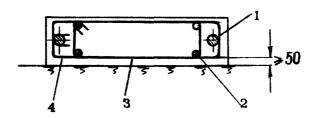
Сечение железобетонной связираспорки с парными затяжками:
